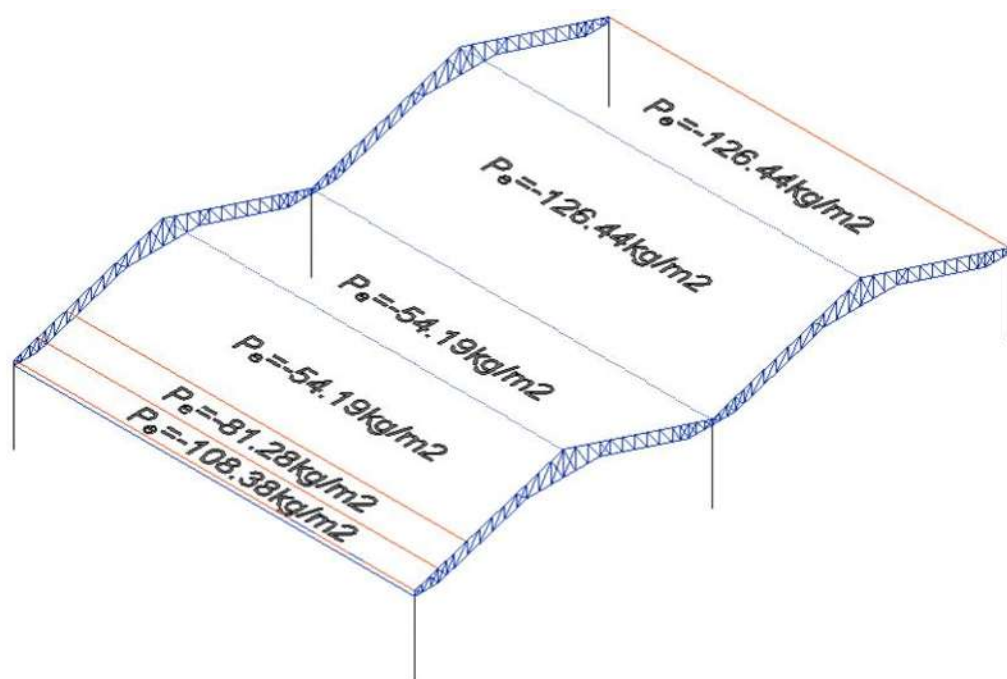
(a) Representación de las presiones exteriores netas para las cubiertas de barlovento y sotavento correspondientes en cada zona, caso 1
